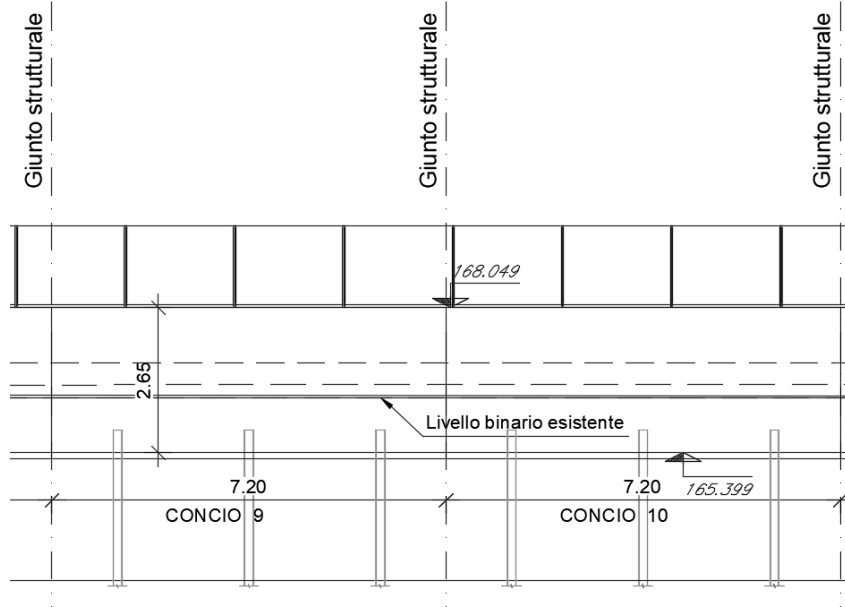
Stralcio planimetrico pensilina su "pensilina tipo 1"
